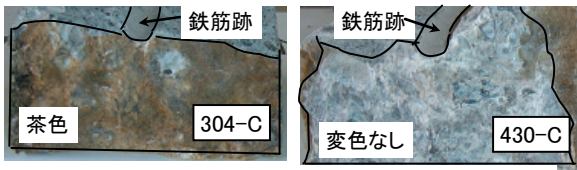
ひび割れ面の変色状況 (暴露 3.8 年)
